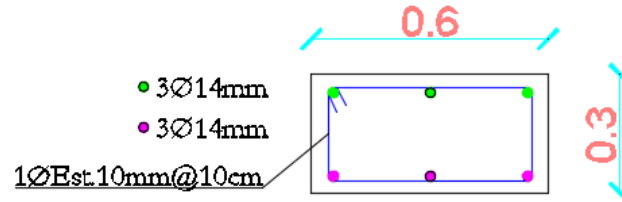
Viga tipo vista en corte Eje A, B, C, 1, 2, 3
